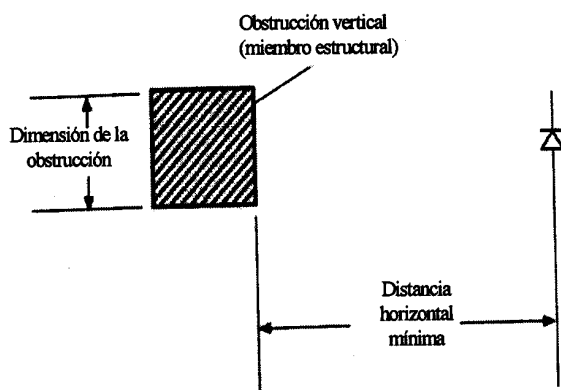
(a) Obstrucciones Verticales
